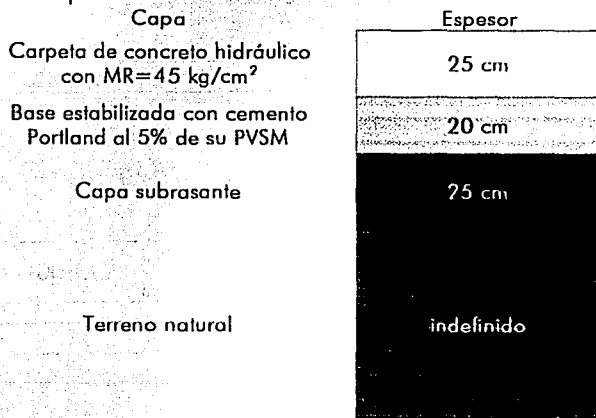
Sección de proyecto a construir según el método de la PCA.
